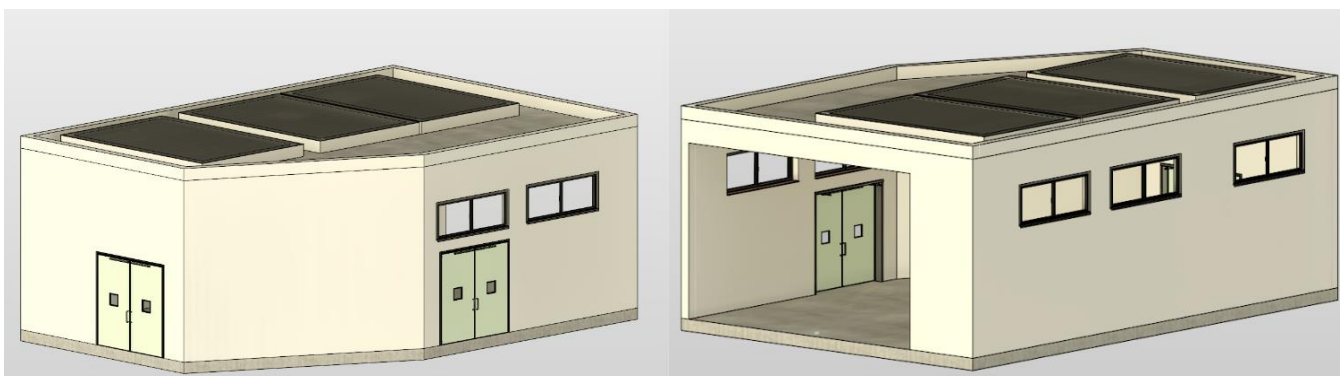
Nachmodellerte maschinelle Vorklärung mit Stahlbetonfassade
